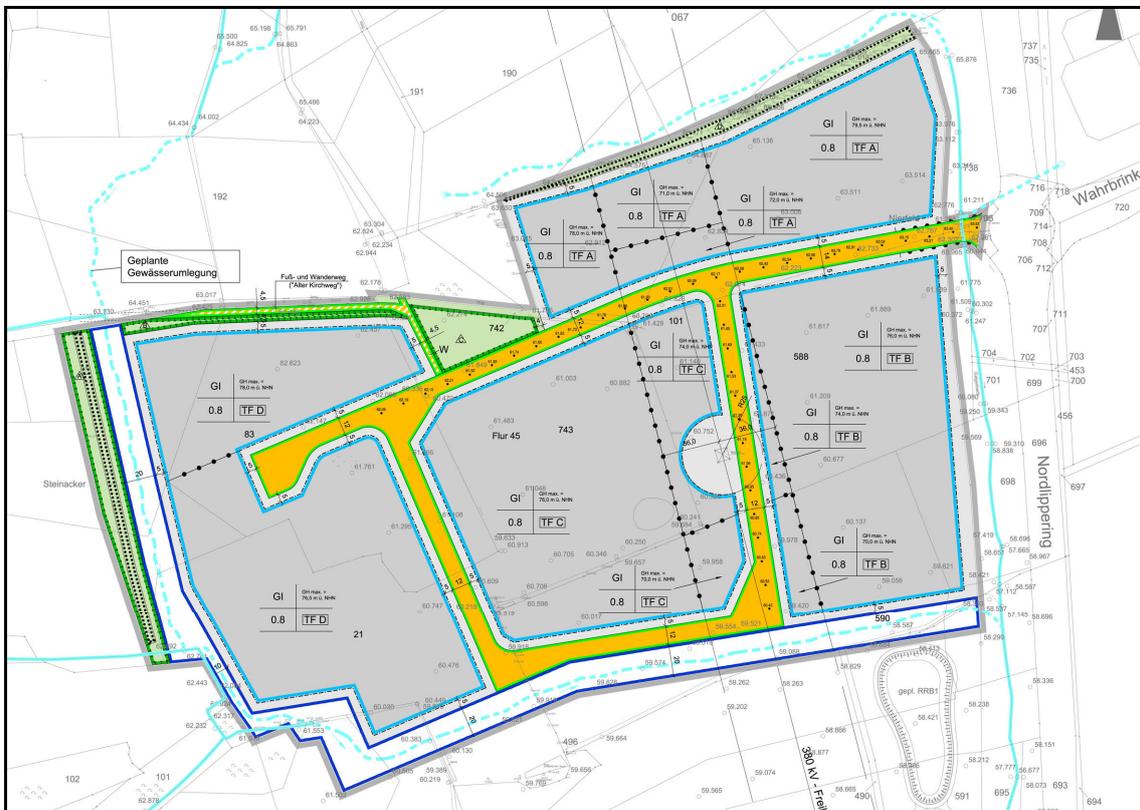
Festsetzungen des Bebauungsplans 23 D aus dem Jahr 2012
